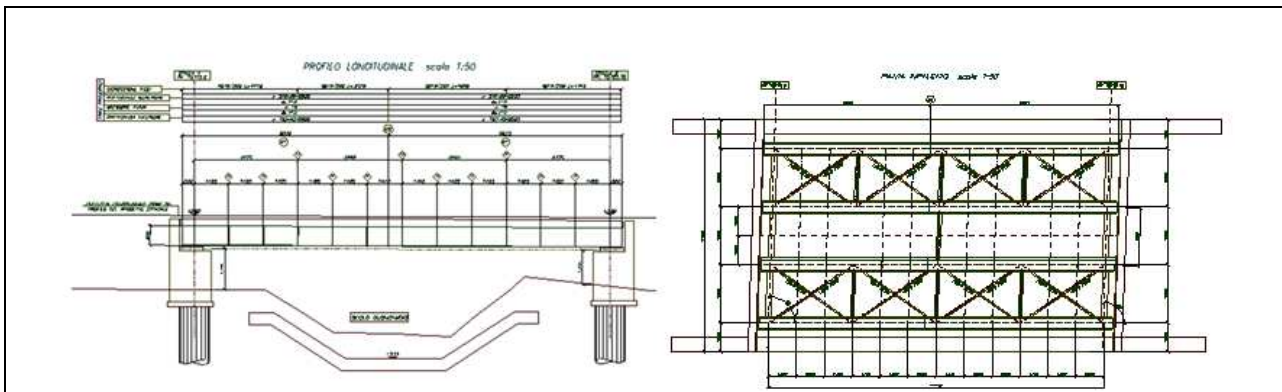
Profilo longitudinale e Planimetria e dell'impalcato Ponte Scolo Buoncambio
